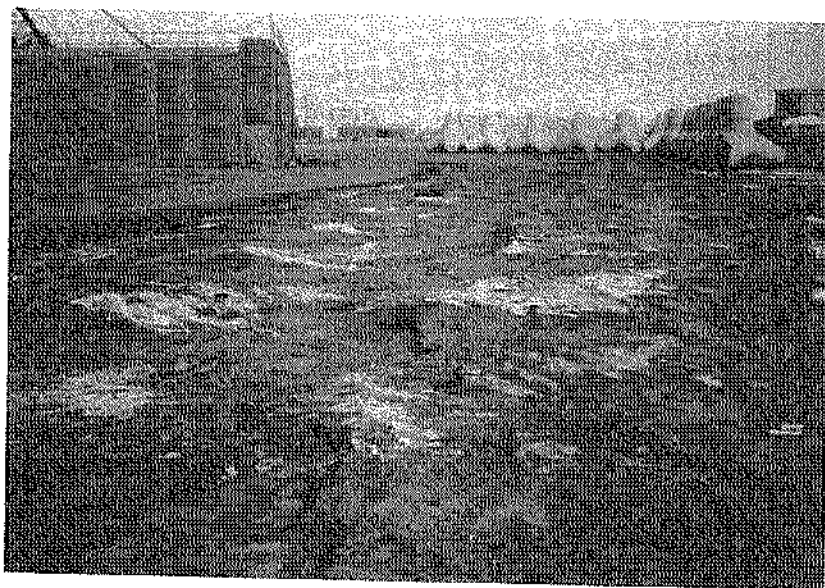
エブロン部沈下状況 (第3埠頭地区, ④東側岸壁(-7.5m))
